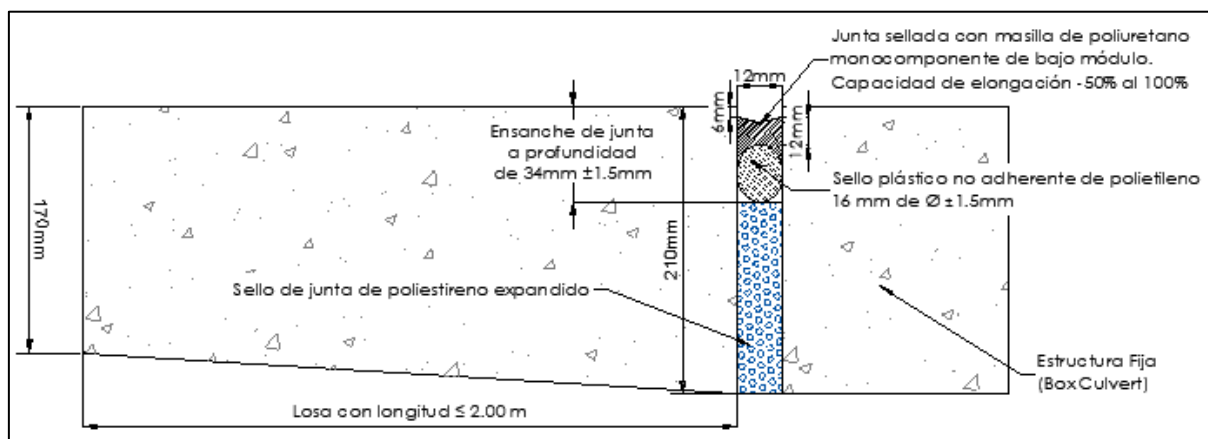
Detalle junta de aislamiento, losas con largo igual o menor a 2.00 m
